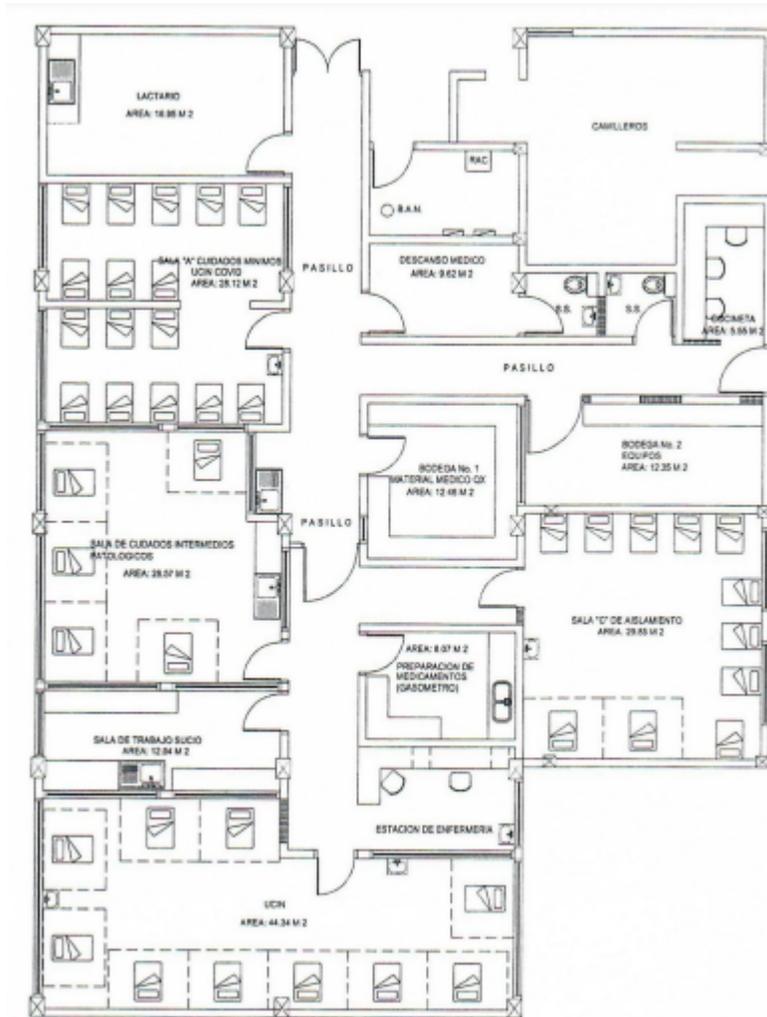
Plano Arquitectónico UCIN-IHSS
